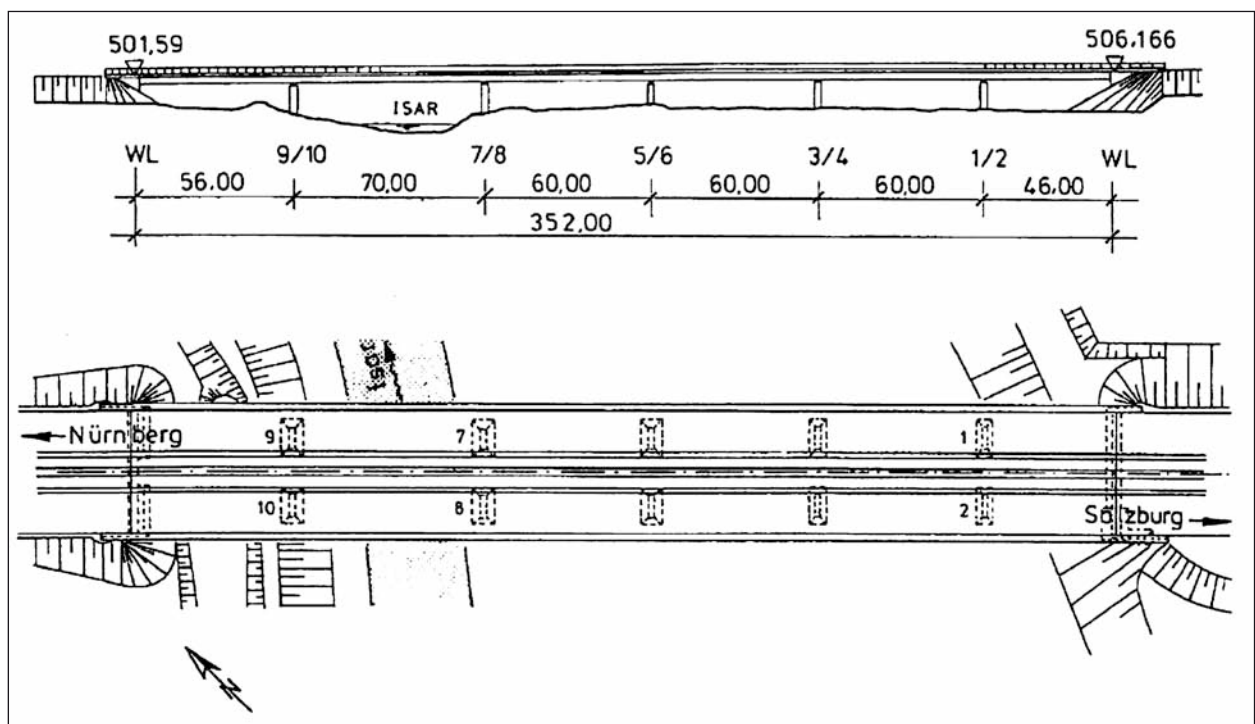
Ansicht und Grundriss der Isarbrücke in Unterführung in München
